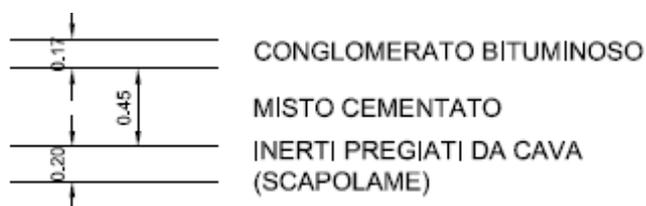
Caratteristiche delle pavimentazioni stradali
